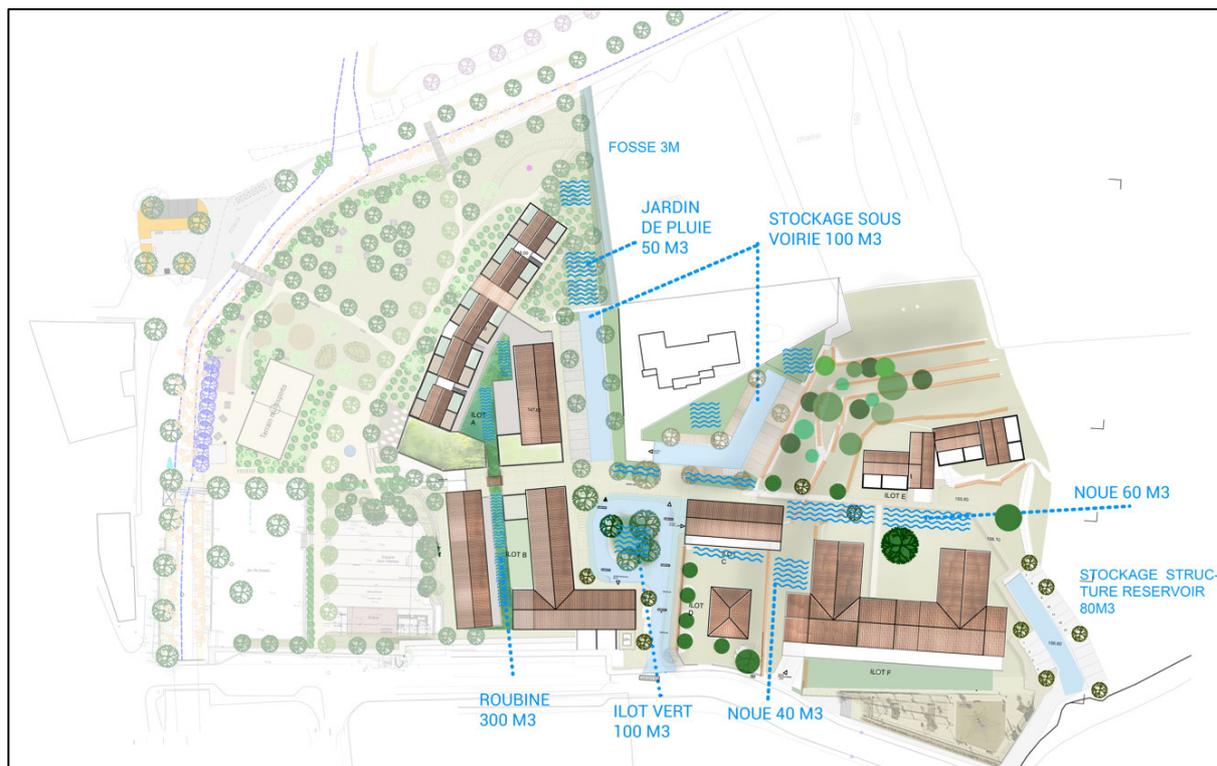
Vue en plan des ouvrages de gestion des eaux pluviales (source : Atelier Pirollet Architectes)
